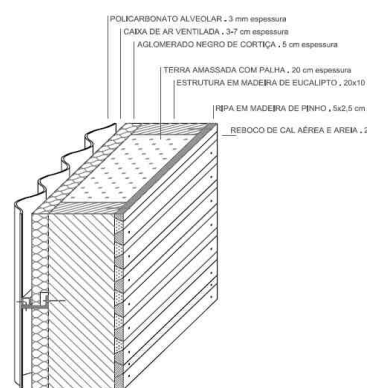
Vista e secção de parede exterior de casa com sistema construtivo alternativo.
